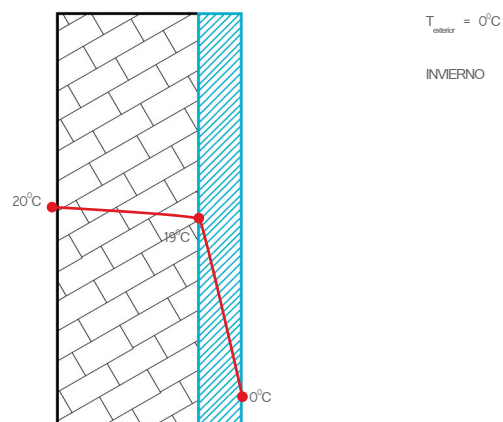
h: Temperaturas en un muro aislado exteriormente (vista corte vertical)
